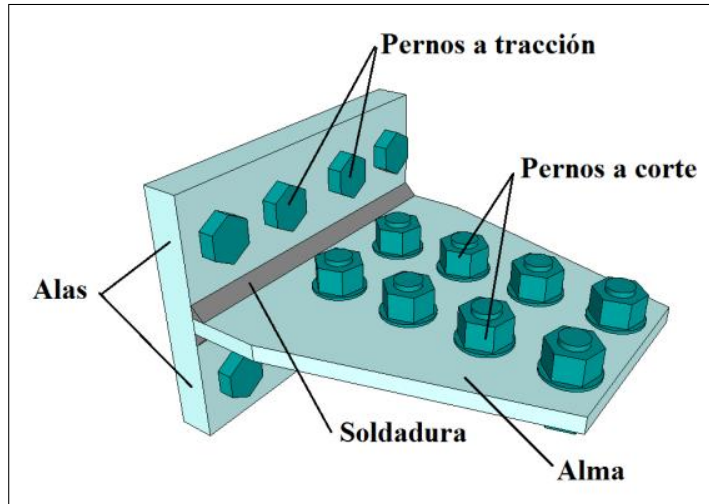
Componentes de un T-stub aislado. Fuente: Salas (2016)
